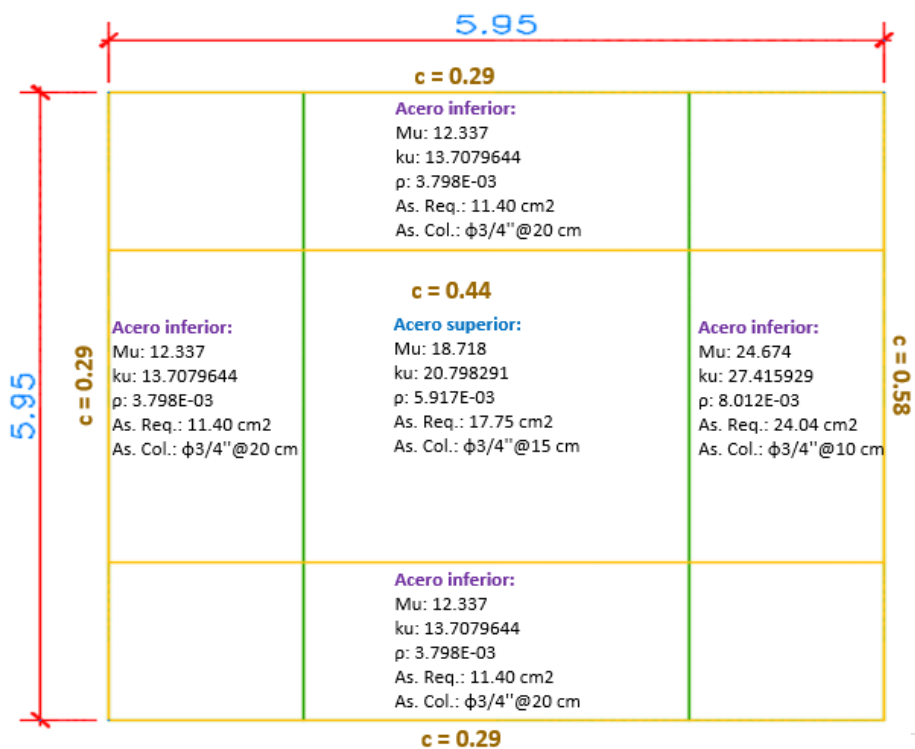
As de la losa - Losa de cimentación con viga - Sistema aporticado
